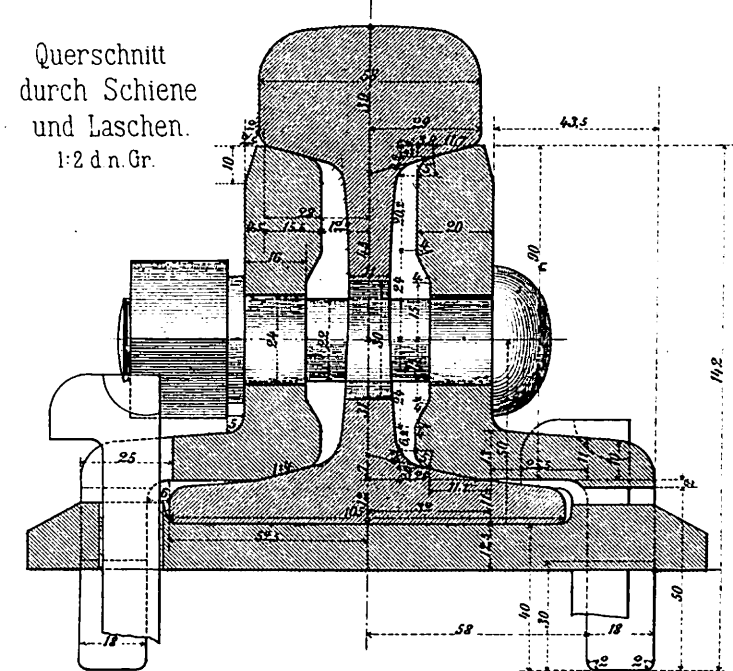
Für Hauptbahnen mit hölzernen Querschwellen.
